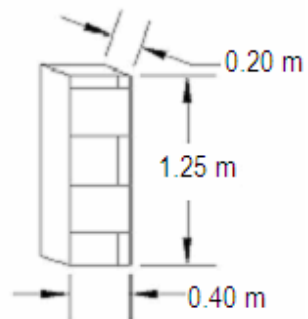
Muro frontal de anclaje de protección prefabricado
